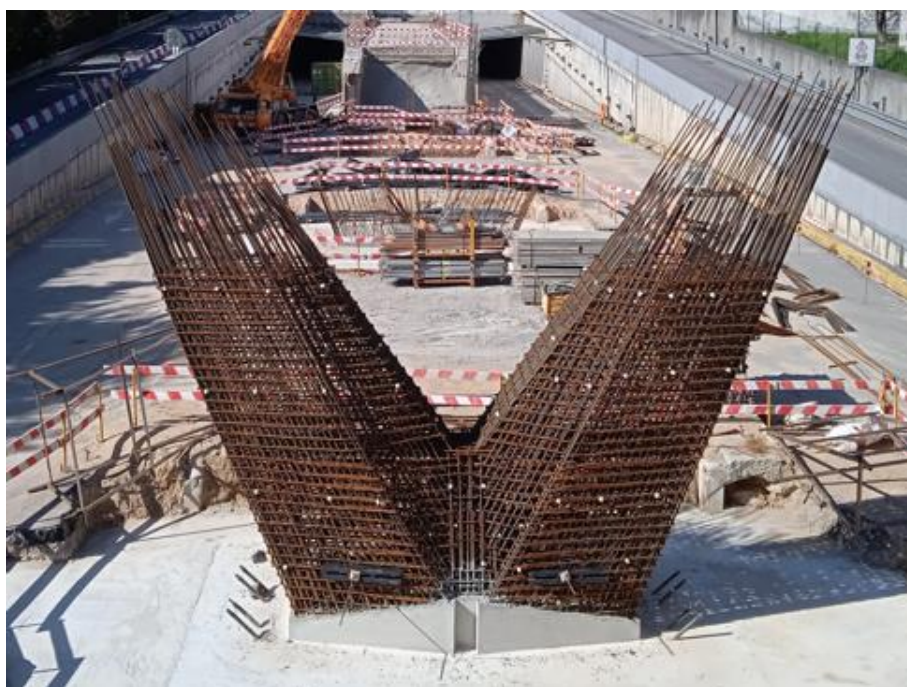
Execução de Armadura Fase 1 e 2 Pilar P3N
